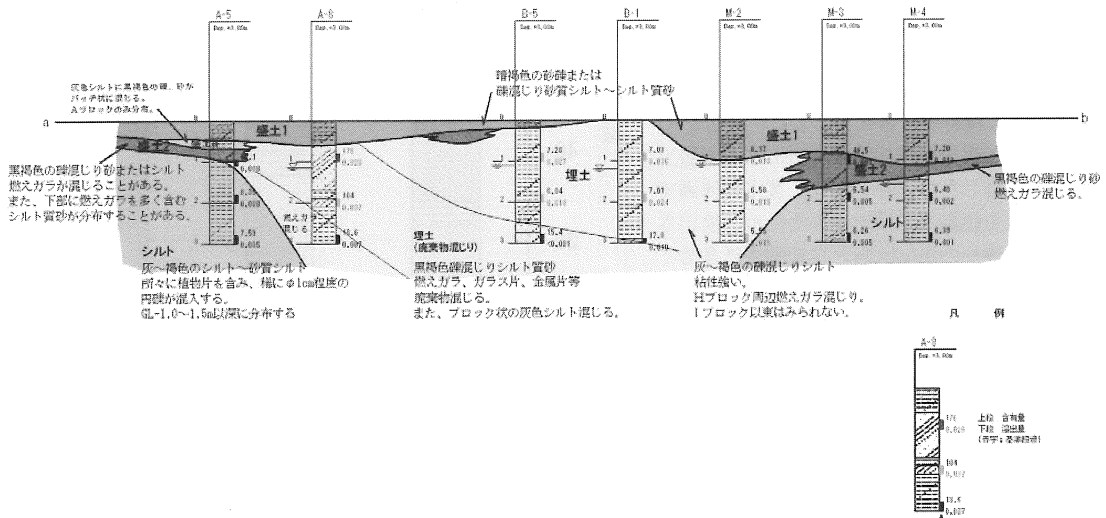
模式土層断面図 (断面の位置は図-9 に示す)
